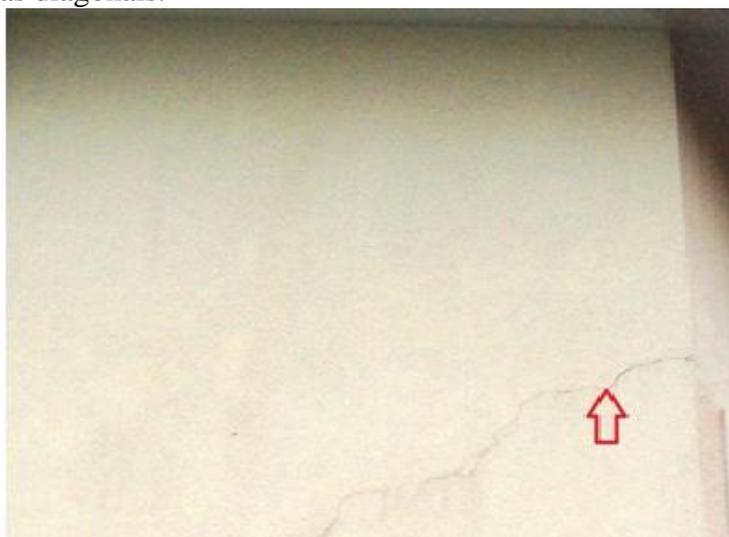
Fissuras diagonais por movimentação térmica de laje.
